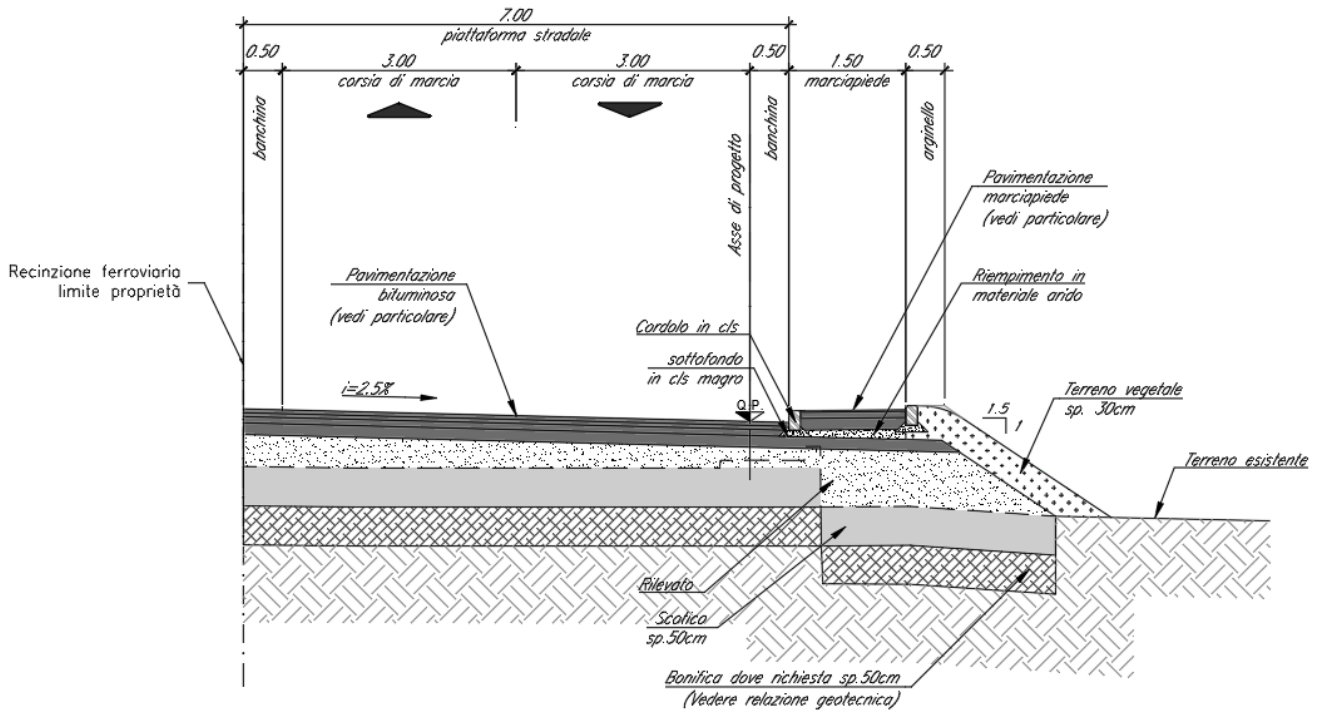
Sezione tipo in rilevato NV16 Asse 2
